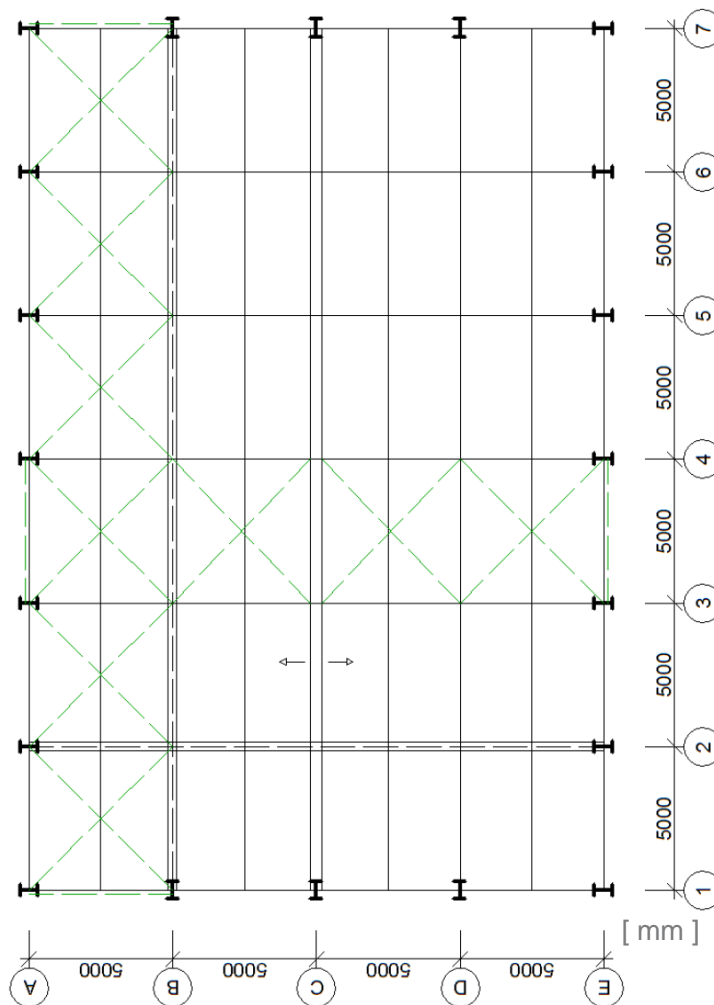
Grundriss –Tragsystem Lagerhalle
